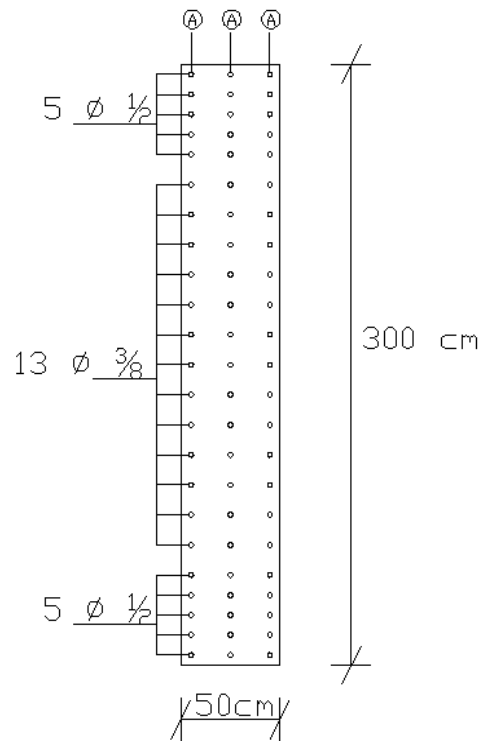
Sección transversal de muro dirección Y nivel 2.
